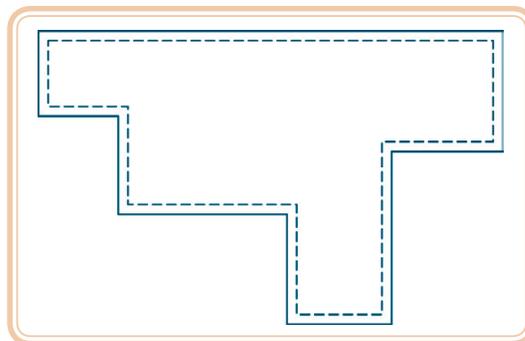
Etapas do traçado de um telhado – perímetro da projeção da cobertura
